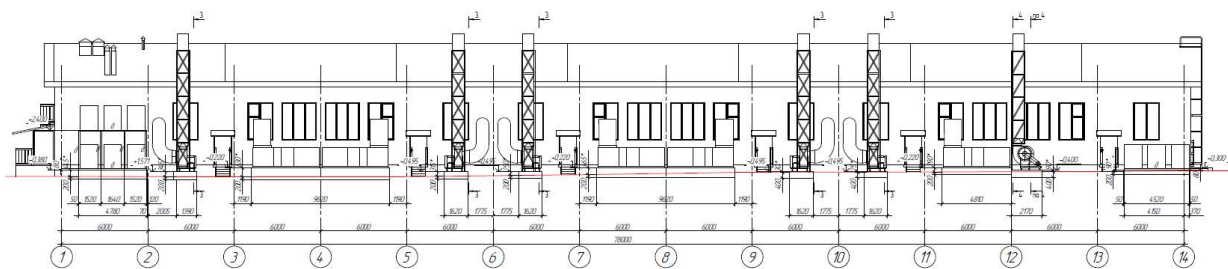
Схема розміщення вентиляційних установок вздовж фасаду 1-14
